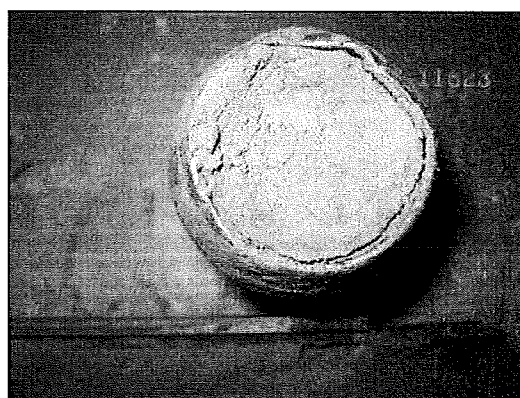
Sondeig S-1. SPT a 12,5 metres.
